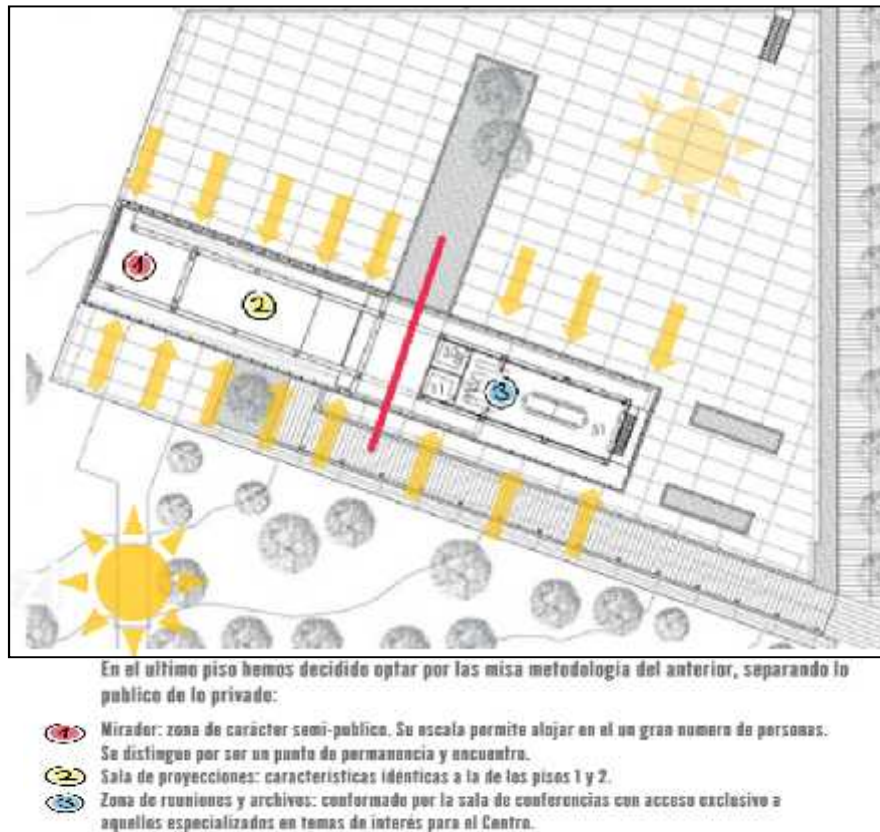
Ilustración 20: Segunda Planta Centro de Interpretación de la Naturaleza
